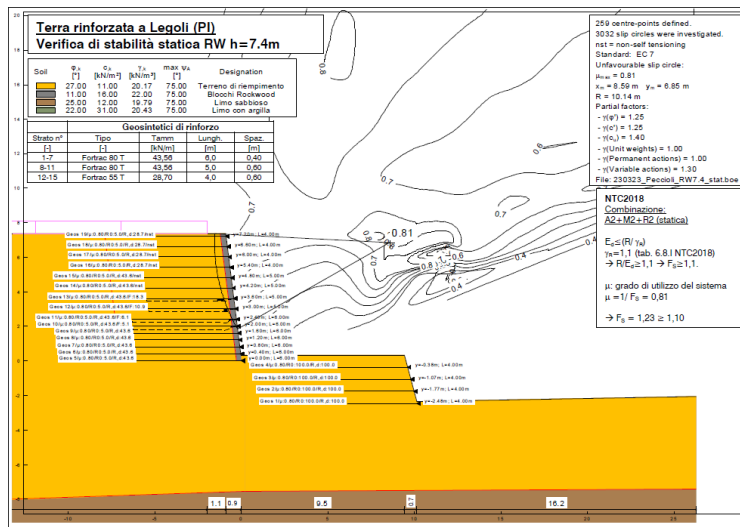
/5 – Verifica muro in TR tipo Rockwood: stabilità statica
